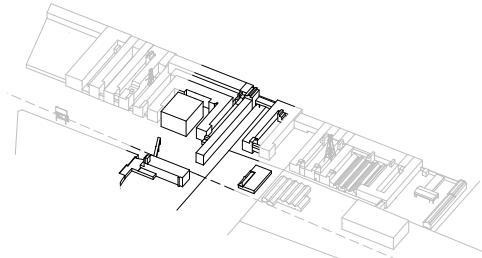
Ausschnitt Grundriss Zone 1
